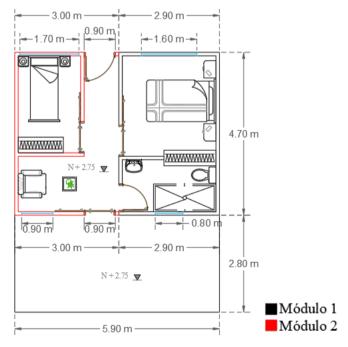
Mobiliario de la planta alta de la vivienda mínima modular.
